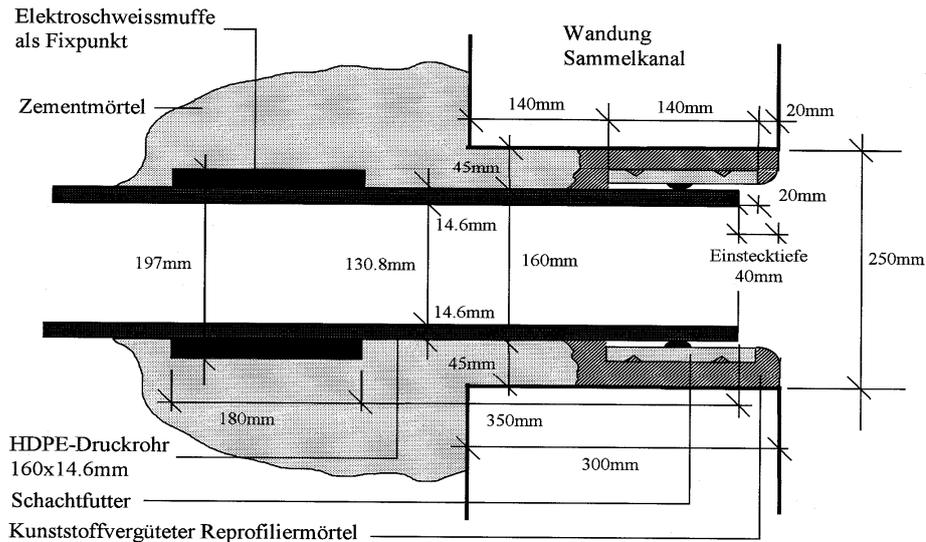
Anbindung einer HDPE-Druckrohr Hausanschlussleitung (160 x 14,6 mm) an einen Beton-sammler
